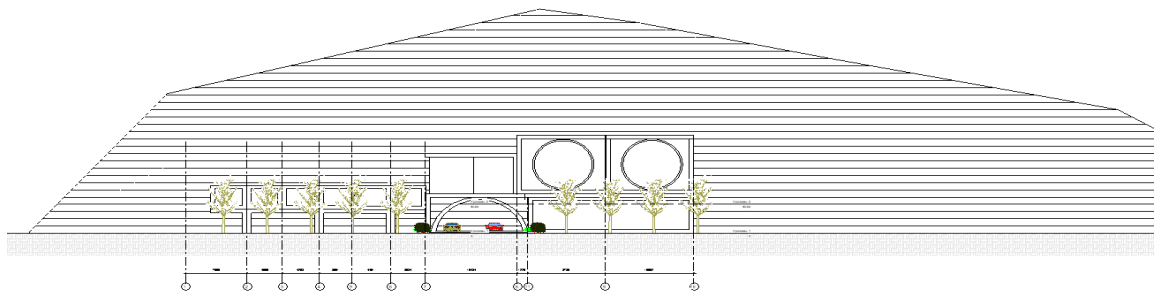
Фасад в осях 1 – 11 по оси А
